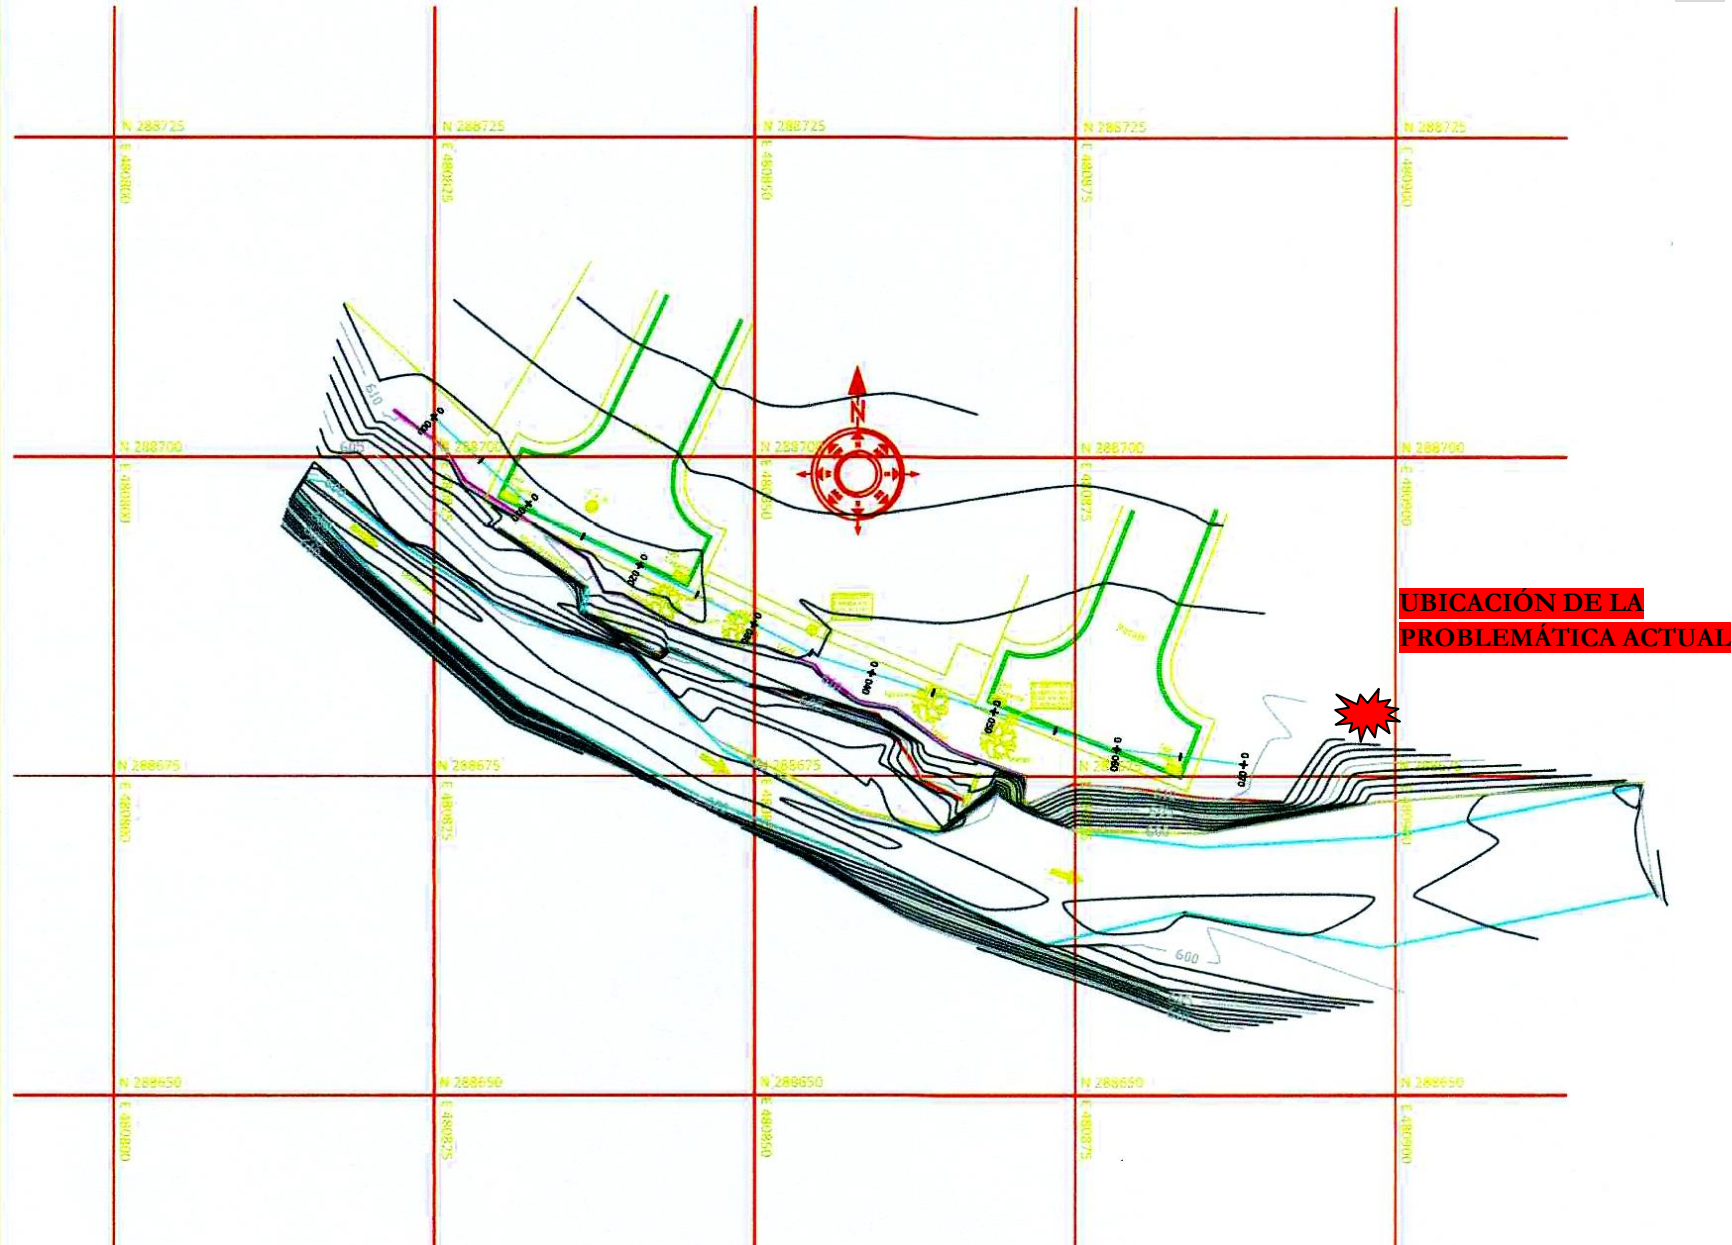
Tomado de los planos presentados de diseño del proyecto La Campiña 2000. Plano de conjunto topográfico y límites del proyecto P/2-(PC) sept. 2015
